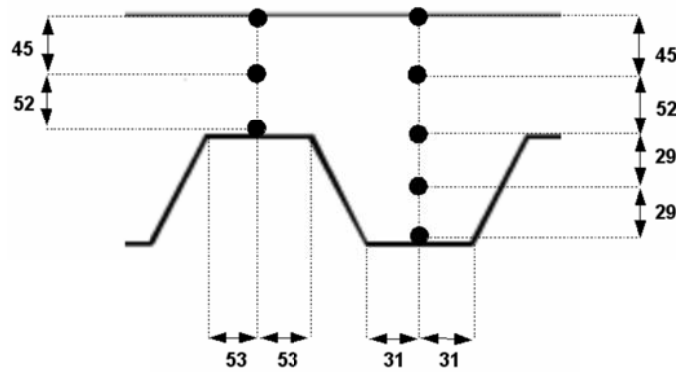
Section droite typique de la dalle mixte montrant les positions des thermocouples
